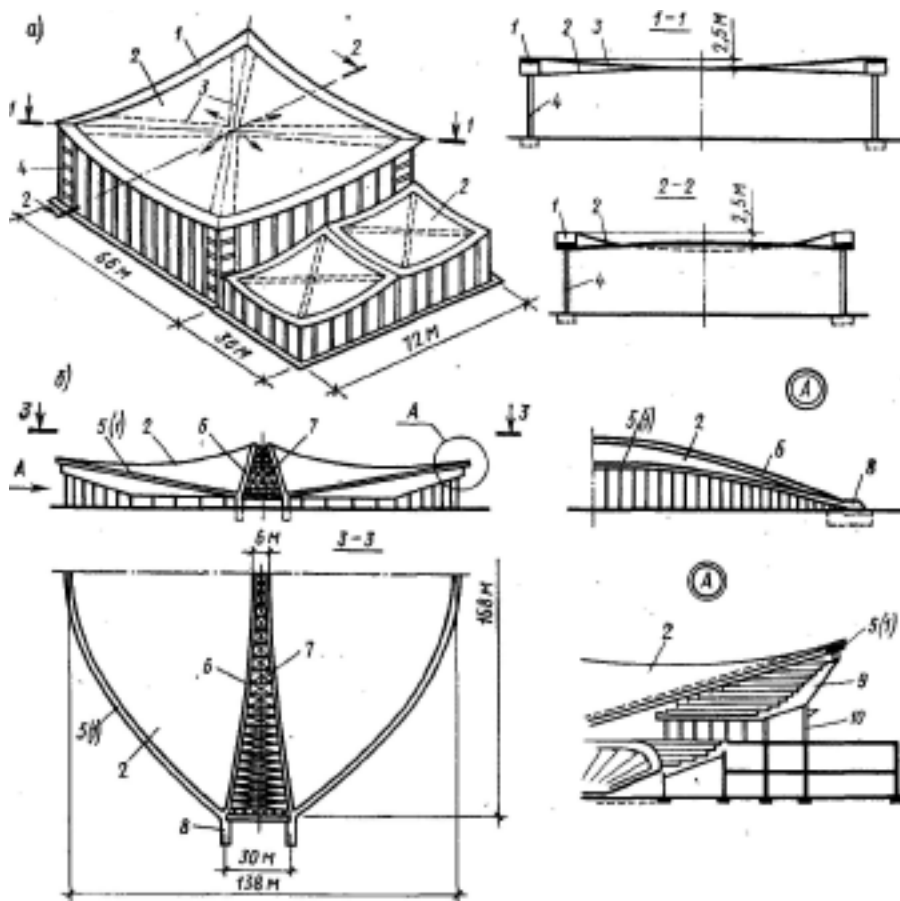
Мембранные покрытия, деревянное висячее покрытие:
